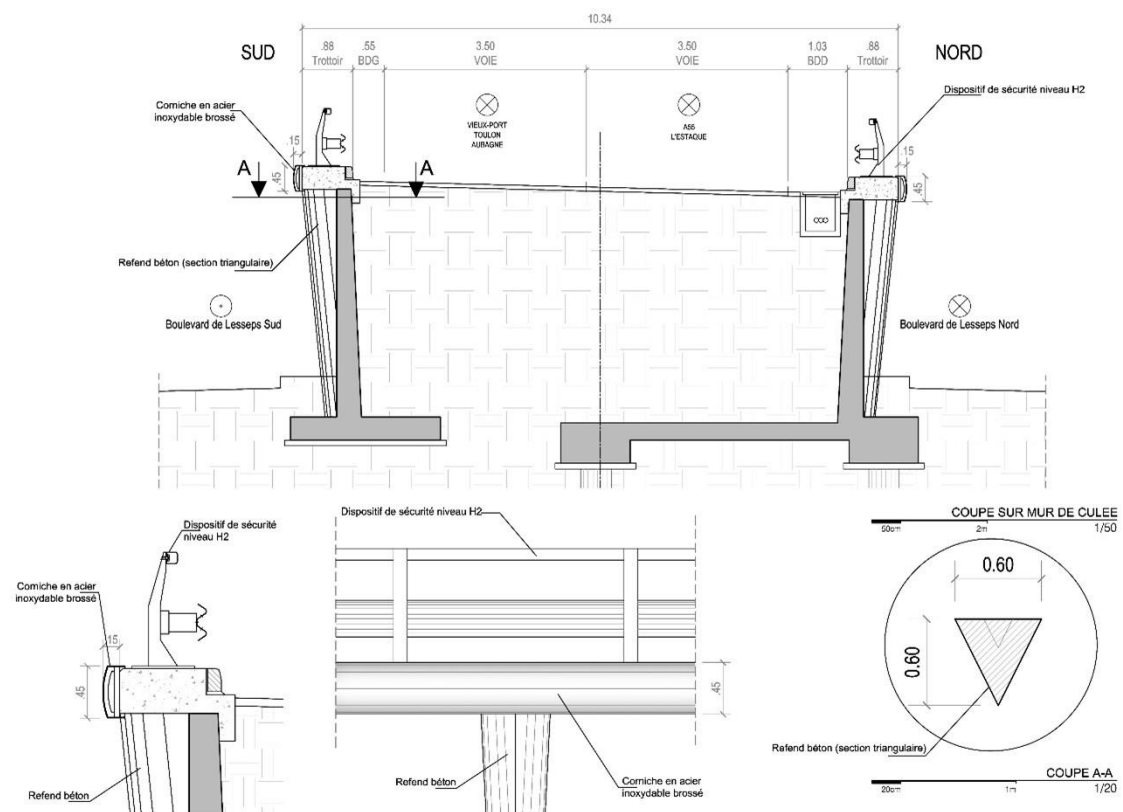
Coupe sur la rampe d'accès à l'ouvrage
